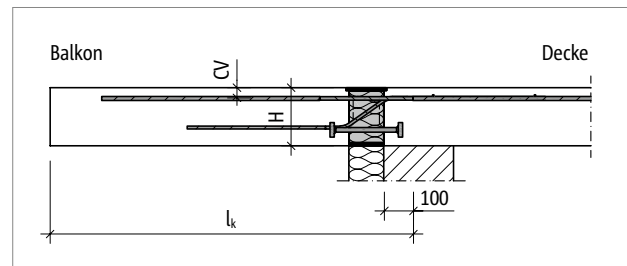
Schöck Isokorb® XT Typ K-M11: Statisches System
